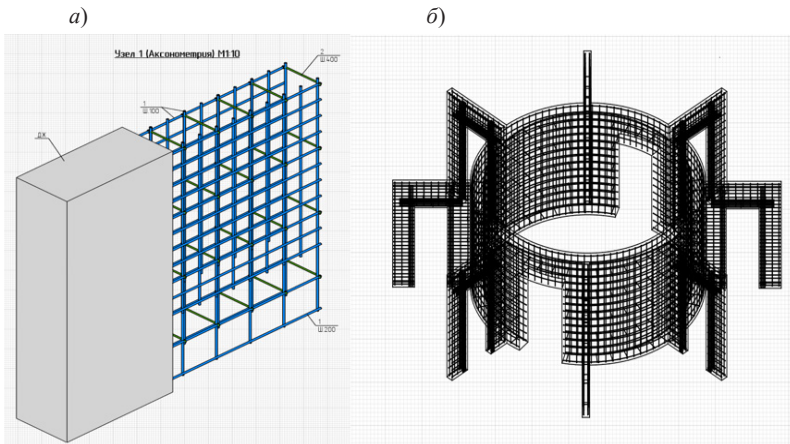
Аксонометрия: а – ж/б стены; б – армирование
